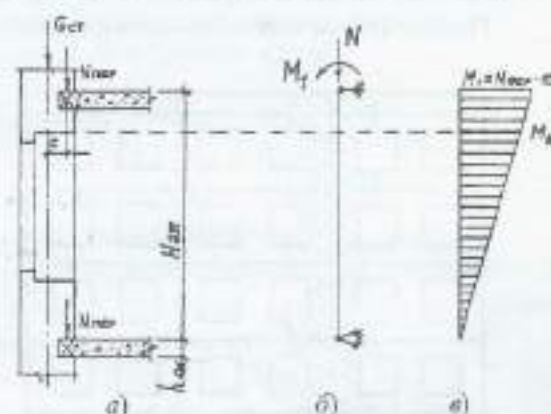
К расчету несущей кирпичной стены: а – конструктивная схема; б – расчетная схема; в – эпюра изгибающих моментов
